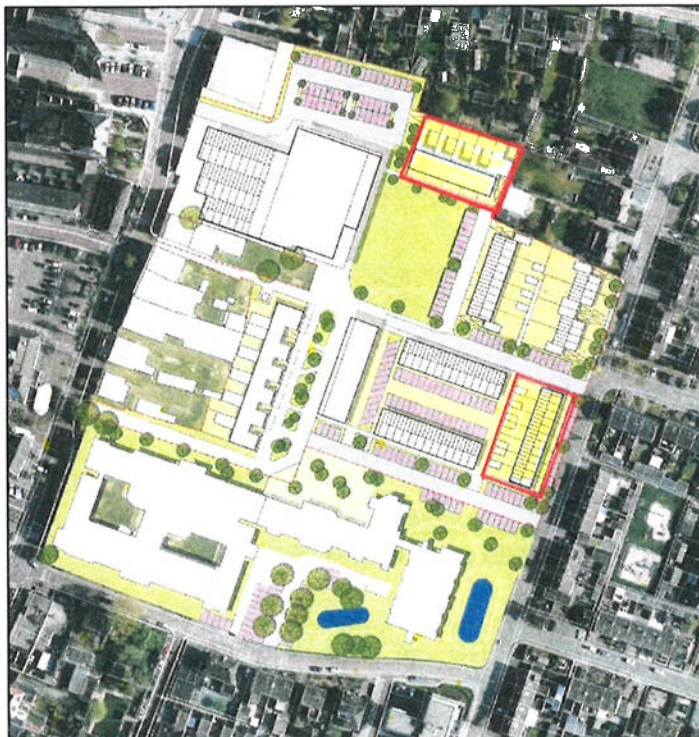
Plangebied (projectmatige woningbouwontwikkeling) Park Maashorst Kamer 4
